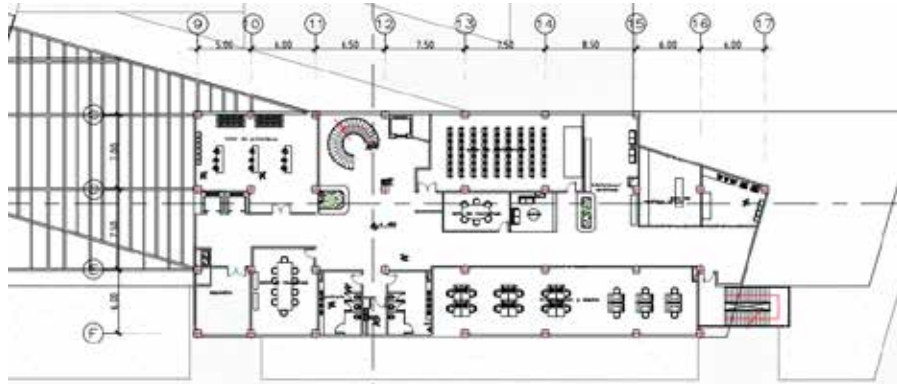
Planta Nivel 2 Fuente: La Autora (2020)
